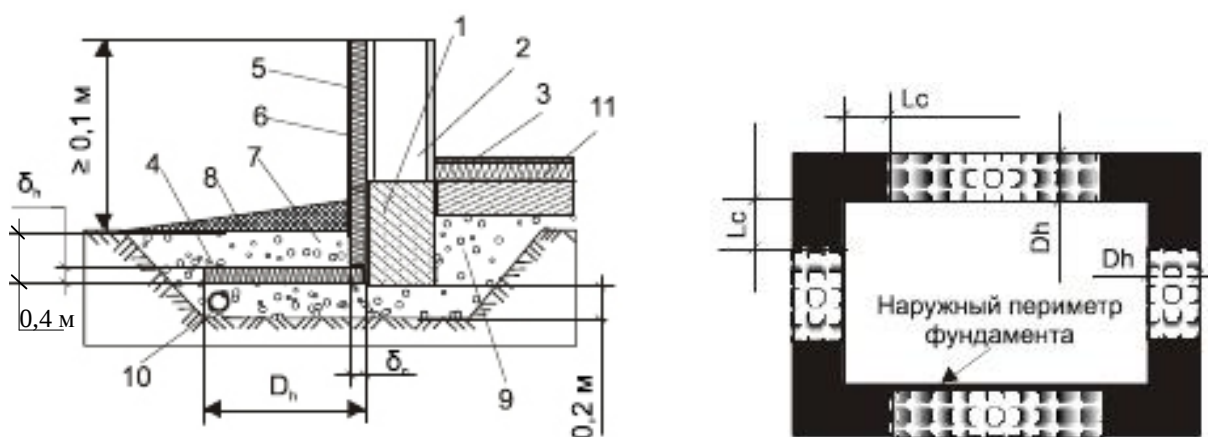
Схема укладки и параметры теплоизоляции в фундаментах отапливаемых зданий с теплоизоляцией пола: 1-фундамент; 2-стена здания; 3-пол здания; 4-горизонтальная теплоизоляция; 5-вертикальная теплоизоляция; 6-защитное покрытие; 7-песчаная подготовка под отмотку; 8-асфальтовая отмотка; 9-непучинистый грунт; 10-дренаж; 11-теплоизоляция пола
